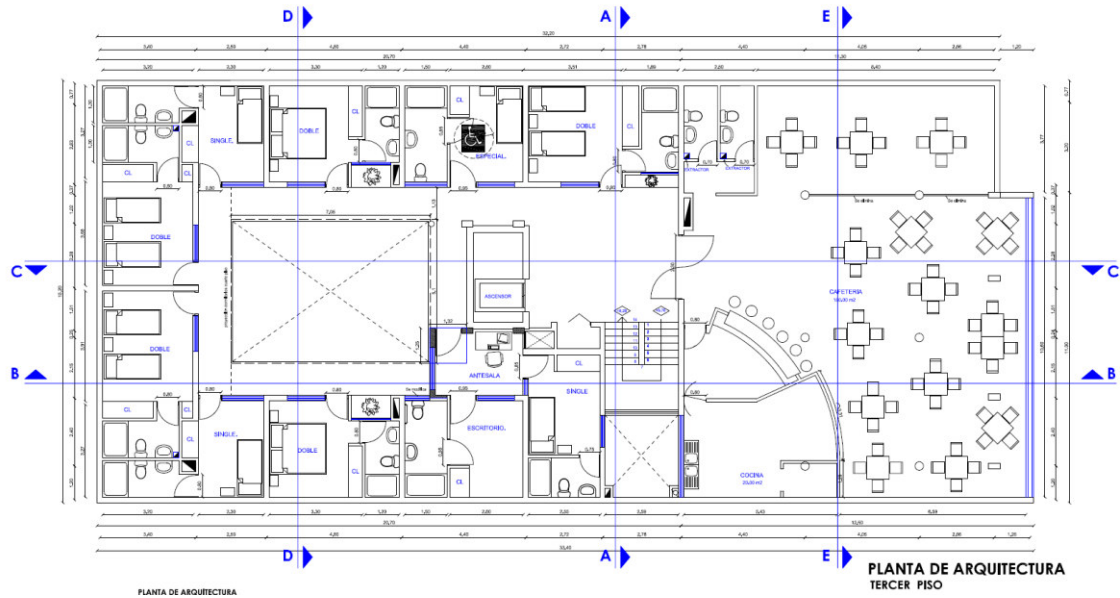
Planta arquitectónica del tercer piso: 400,17 m2
